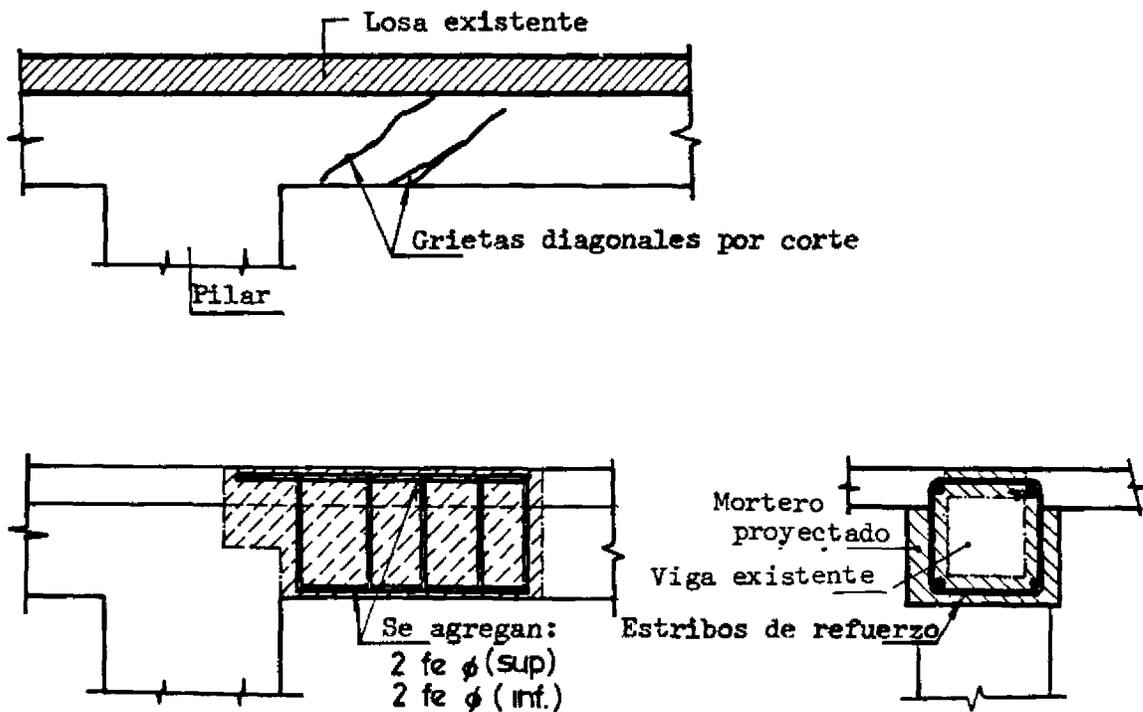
Caso V-3. FALLA POR ESFUERZO DE CORTE (refuerzo de armadura y encamisado con mortero proyectado (Sidney Johnson))
